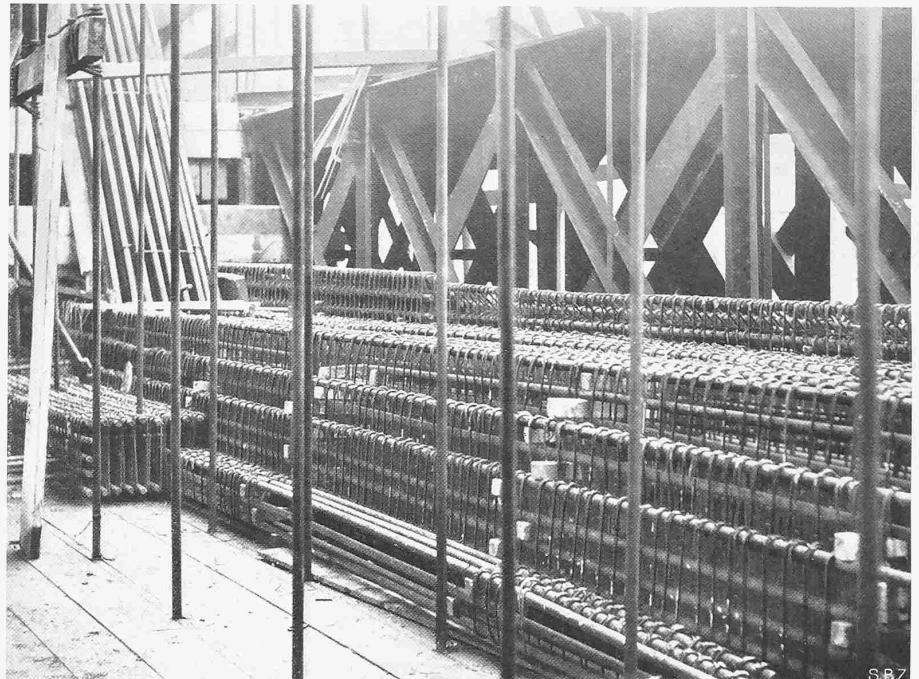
Ferrailage de la membrure inférieure de la poutre maîtresse. (A droite, poutre métallique B.)
